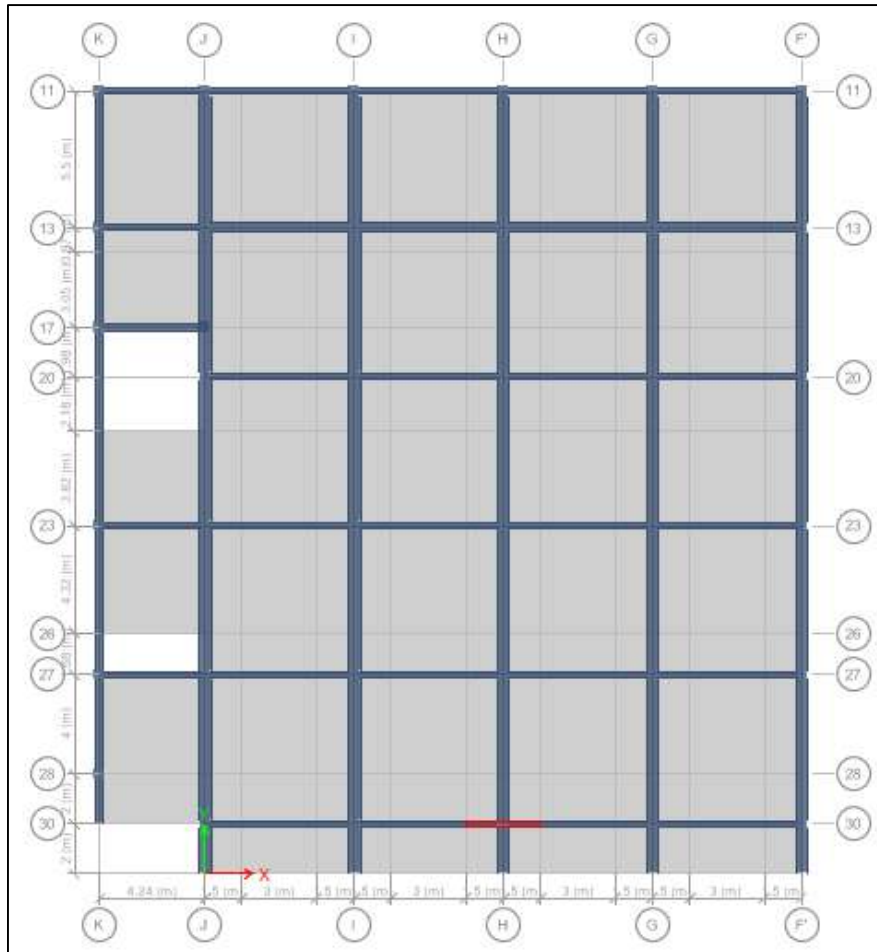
Planta N+0.00 Estructura 5.32 Hotel
